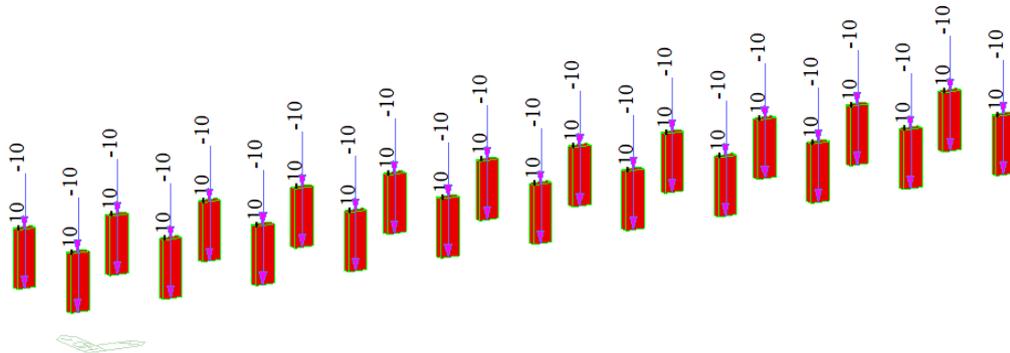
Modello FEM. Forza d'inerzia elementi beam. SLV Z- [kN/m]
